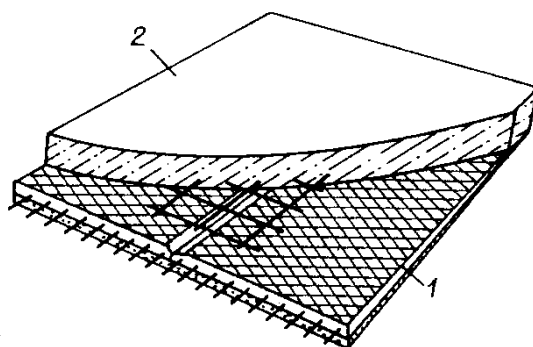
Перекрытия системы *ISO* с использованием предварительно напряженных железобетонных плит в качестве оставляемой опалубки
